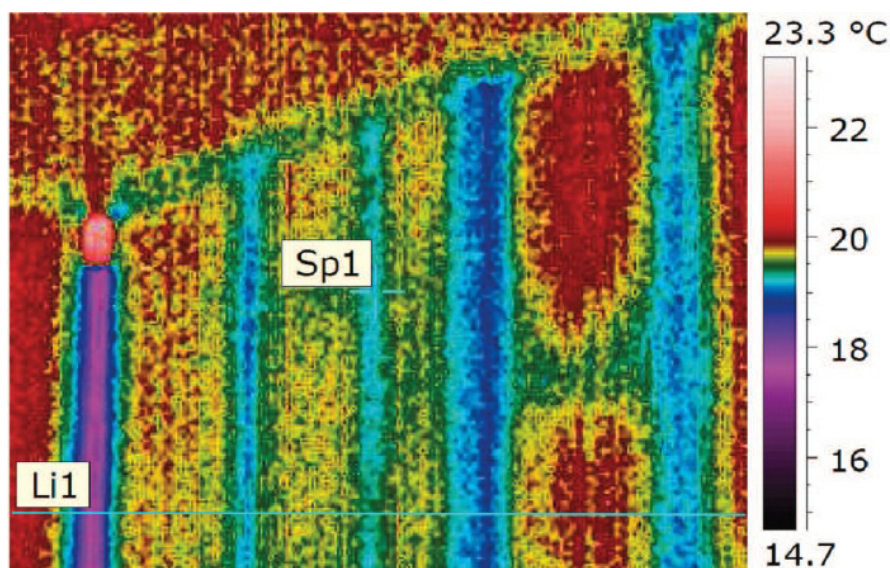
Тепловизионная съемка внутренней стены фасада с облицовкой штукатуркой
